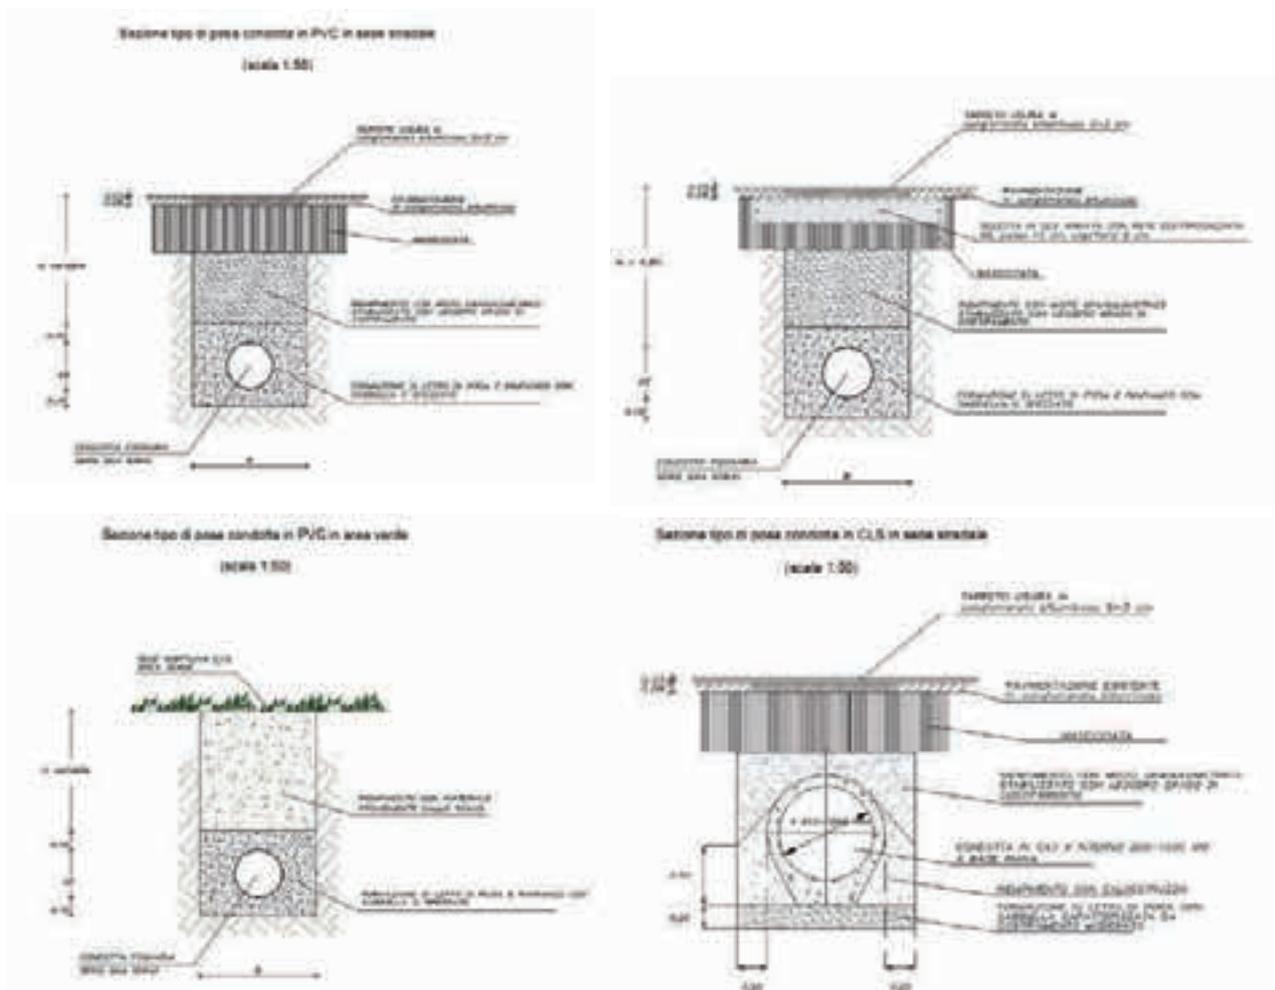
Sezioni tipiche di posa delle tubazioni adottate in progetto.
